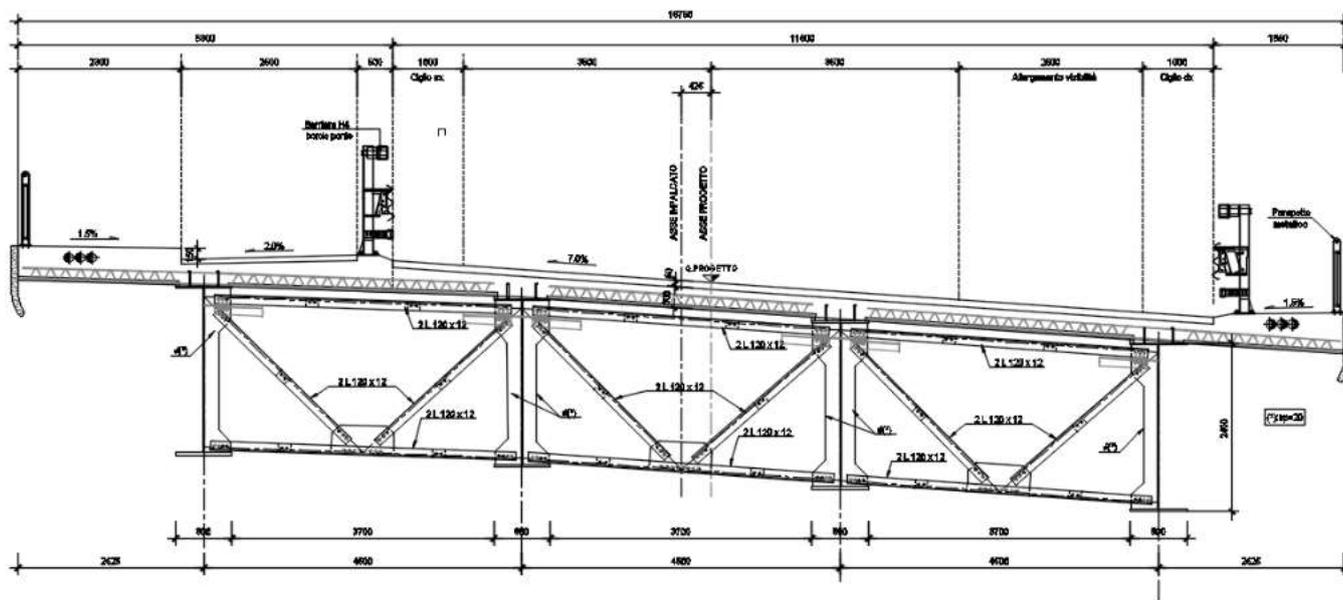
SEZIONE TRASVERSALE PROGETTO ESECUTIVO
